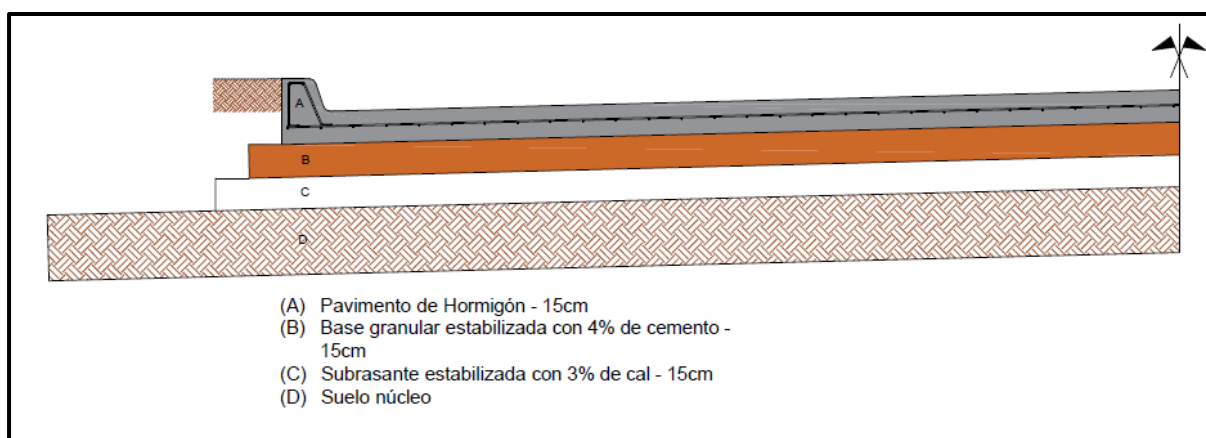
Paquete estructural propuesto para calles internas de la urbanización.
